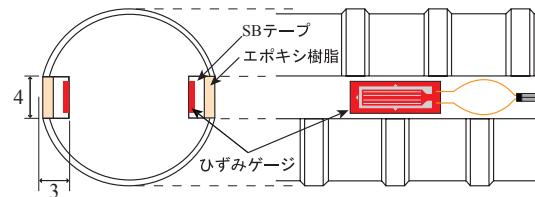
溝切り鉄筋のひずみゲージ貼り付け状況(単位mm)
